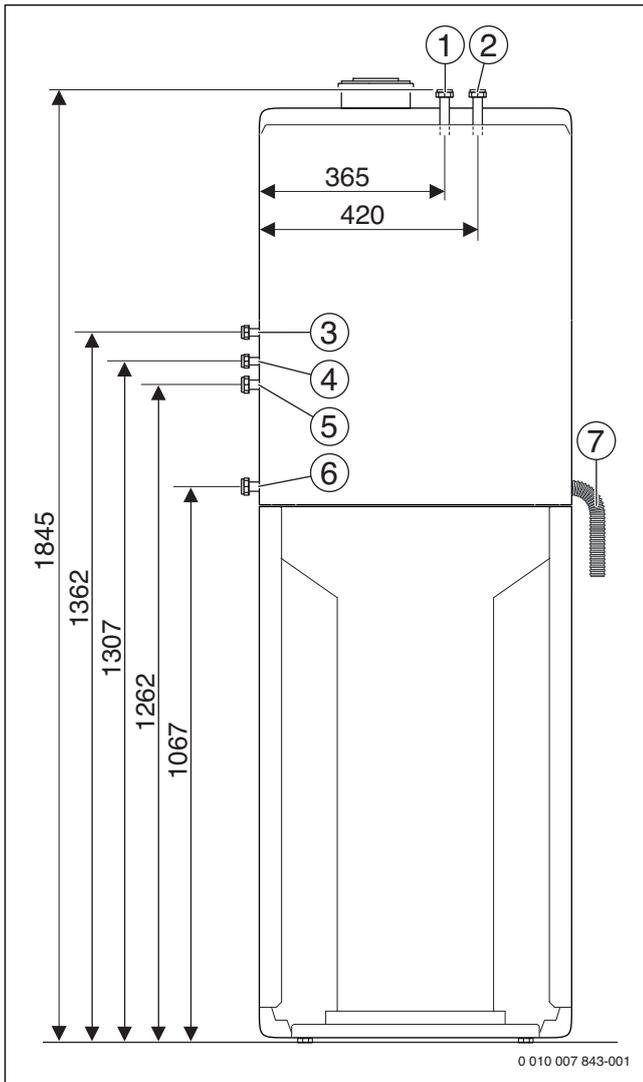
Anschlussmaße des Zubehörs Heizkreiserweiterung 1 (Maße in mm)
